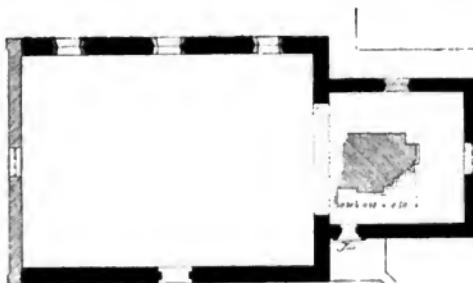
Grundriss der Kirche. 1/20.
